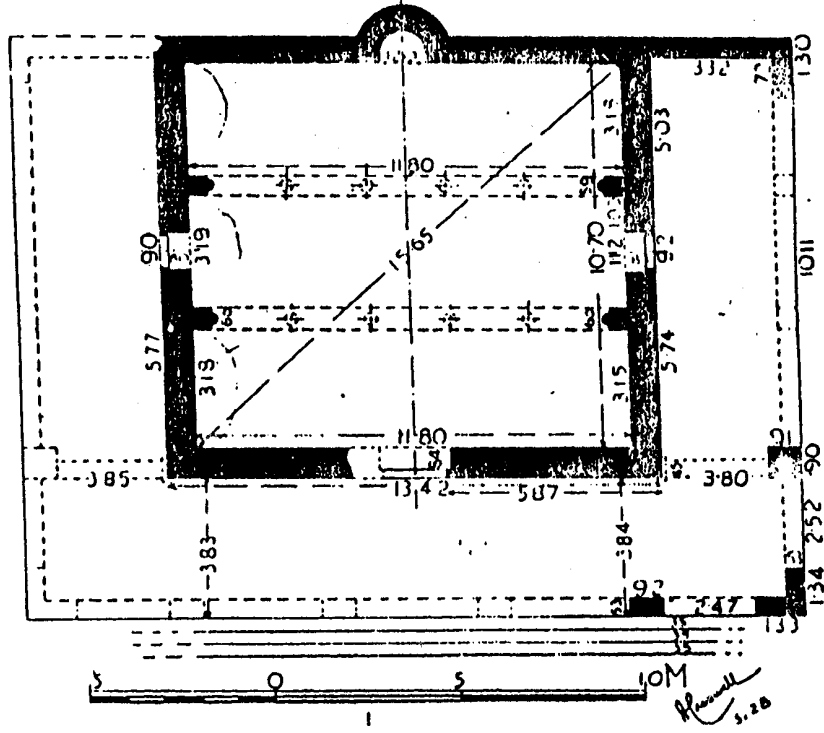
مسقط أفقي لمسجد المدجنين بطليطلة (عن : Moreno)
